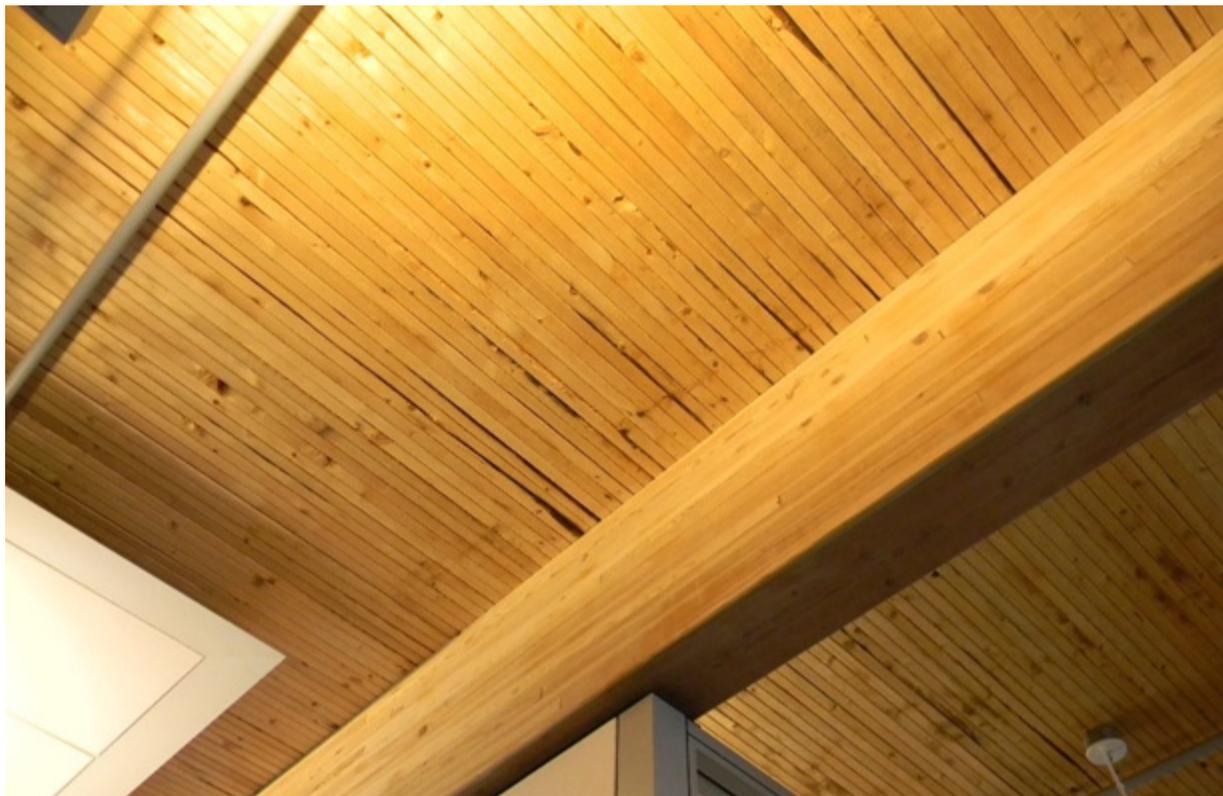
Plancher en bois lamellé-cloué (photo : M. Alexander)
